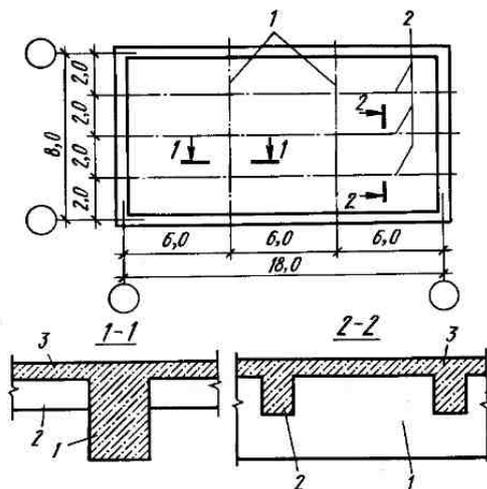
Железобетонное монолитное ребристое перекрытие:
